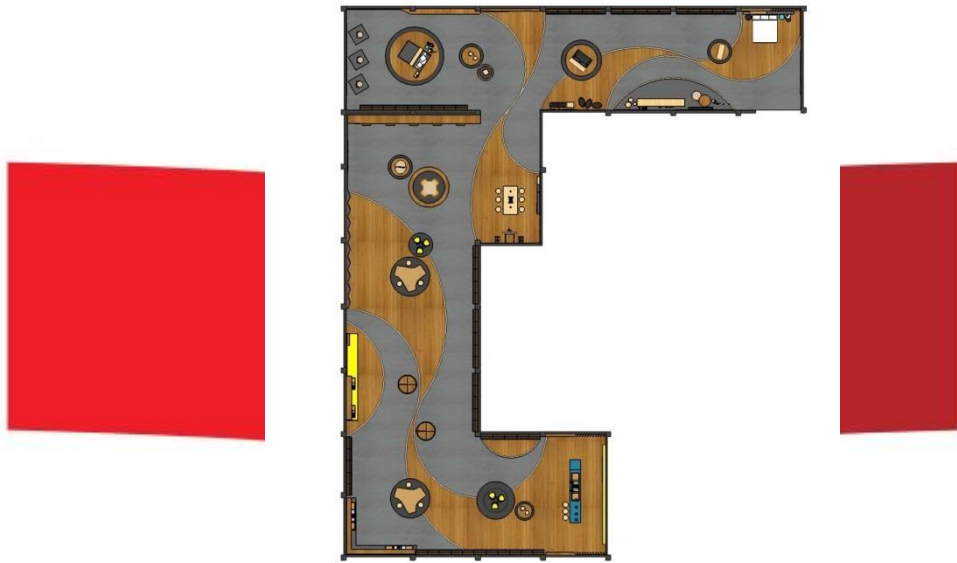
Visualisasi Denah Khusus Showroom Lantai 2
